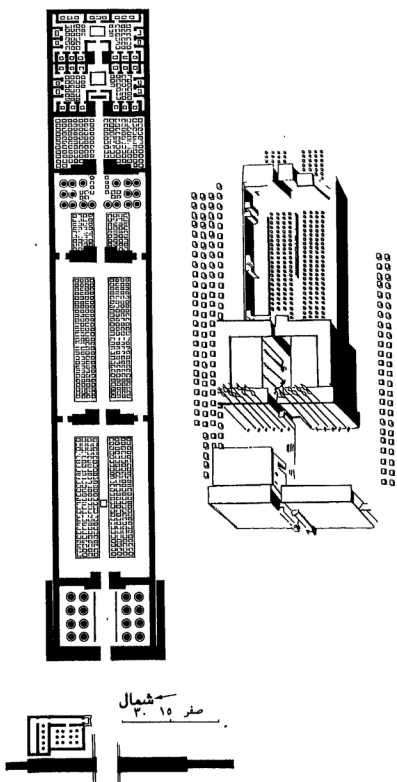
مسقط أفقي للمقر الرسمي للملك.
